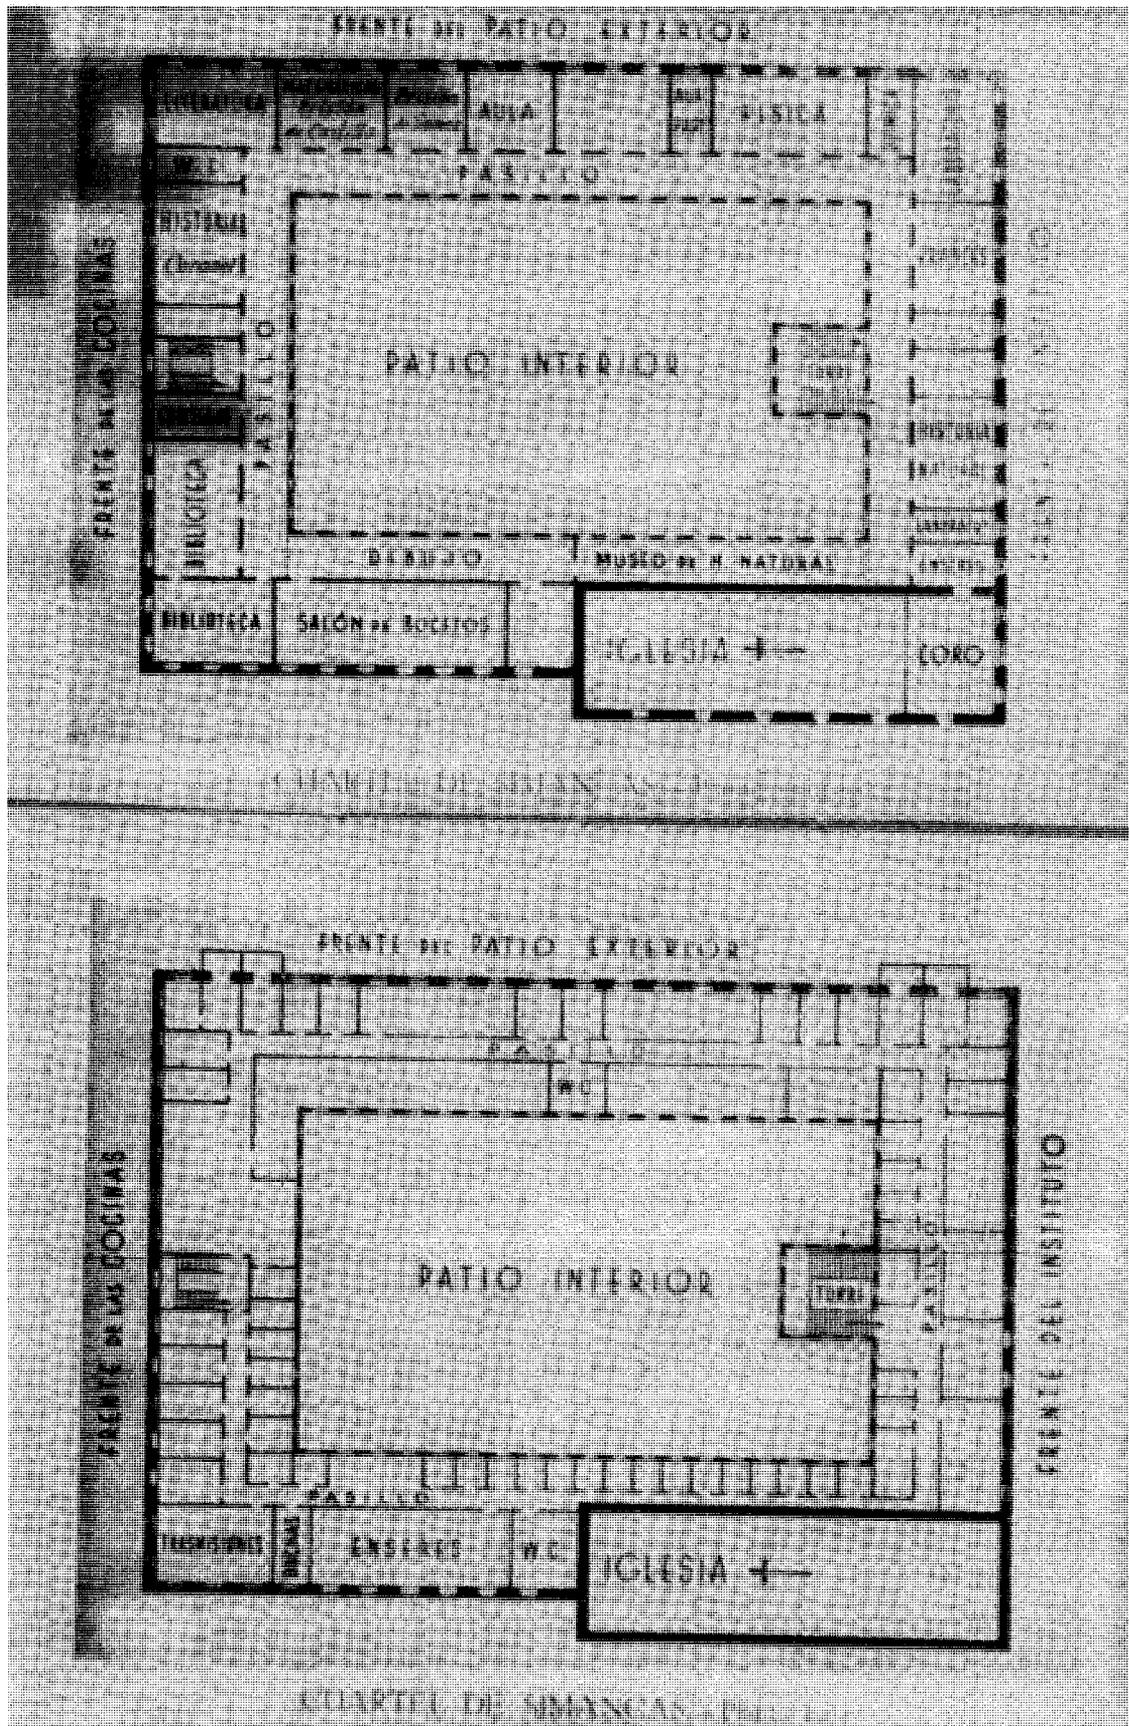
PLANO DE LAS DOS PLANTAS DEL EDIFICIO
